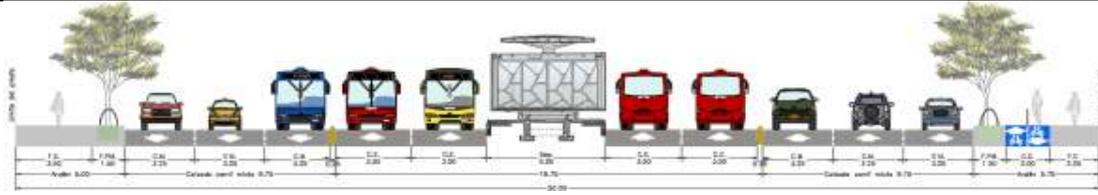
Sección Típica sobre la Autopista Sur entre la Av. 1 de Mayo y la CL 8 Sur. Fuente: Elaboración Propia 2017.
